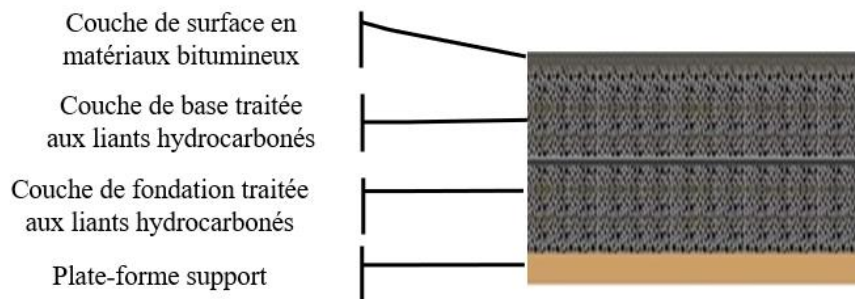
Structure d'une chaussée bitumineuse épaisse.
